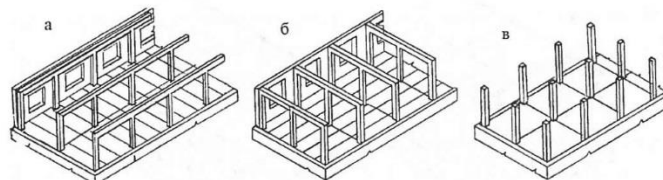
Схема існуючих каркасних систем: 1 – з поздовжнім розташуванням ригелів, 2 – з поперечним розташуванням ригелів, 3 – безригельна каркасна система.
